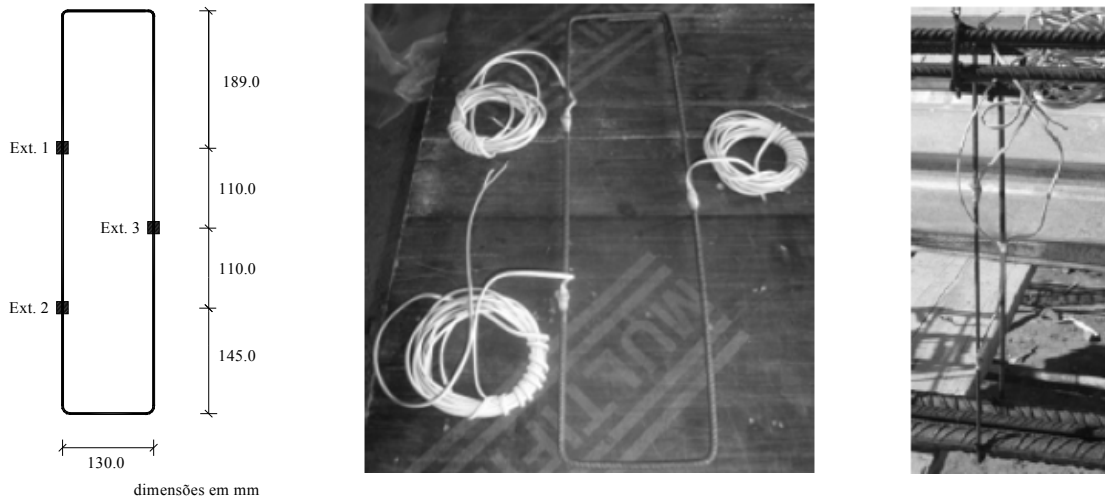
Disposição dos três extensómetros aplicados no estribo de aço instrumentado (Ext.1, Ext.2 e Ext.3).
